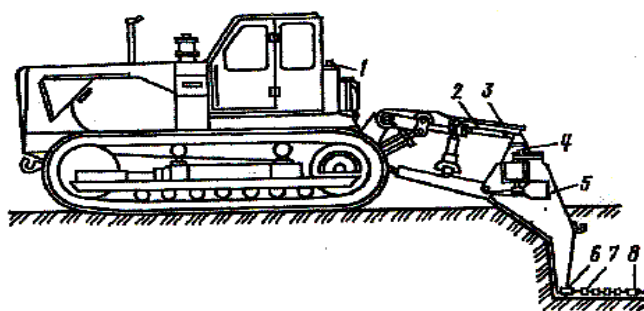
Схема кротователя МД-6: 1 – трактор; 2 – гидроцилиндр поворота рабочего органа; 3 – указатель глубины; 4 – рама; 5 – нож; 6 – направляющий конус-кротователь; 7 – цепь; 8 – дреноуширитель
